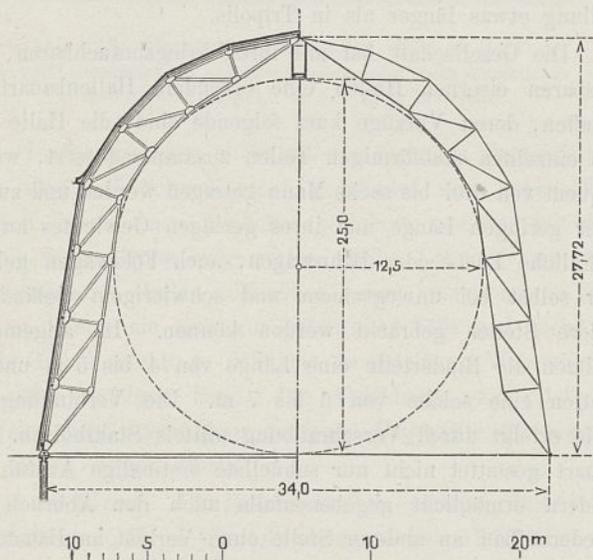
Versetzbare einschiffige Halle in Eisen.
